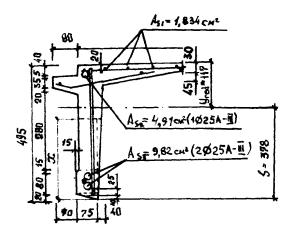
Расчетное опорное сечение 1 верхнего пояса
